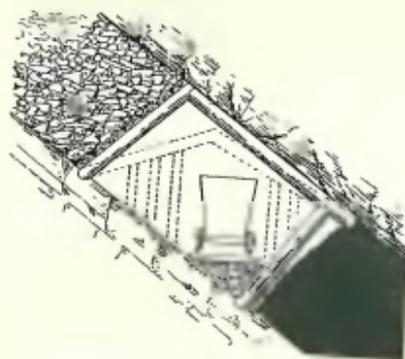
Nachgiebige Schalholzzimmerung in Abbaustrecken.
